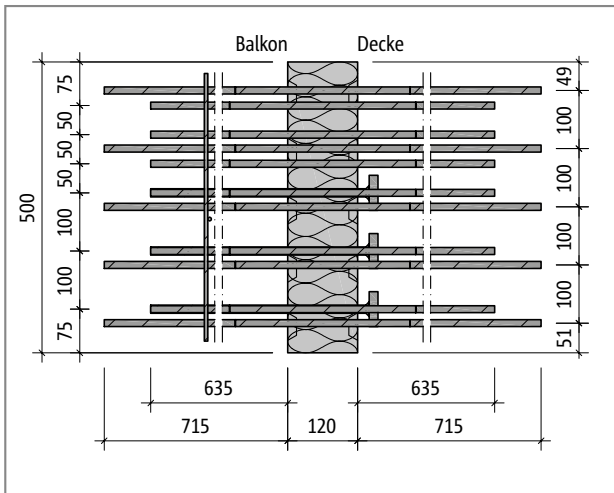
Schöck Isokorb® XT Typ C-L-M2-V2: Produktgrundriss
